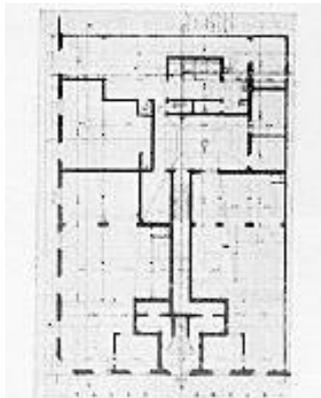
Casa de Félix Buxareo — Planta baja.
